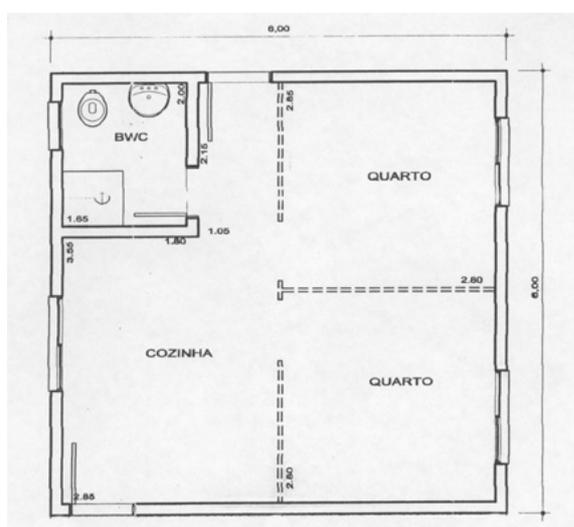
Planta do projeto original (reparem que a posição da porta foi mudada durante a construção em todas as unidades)
